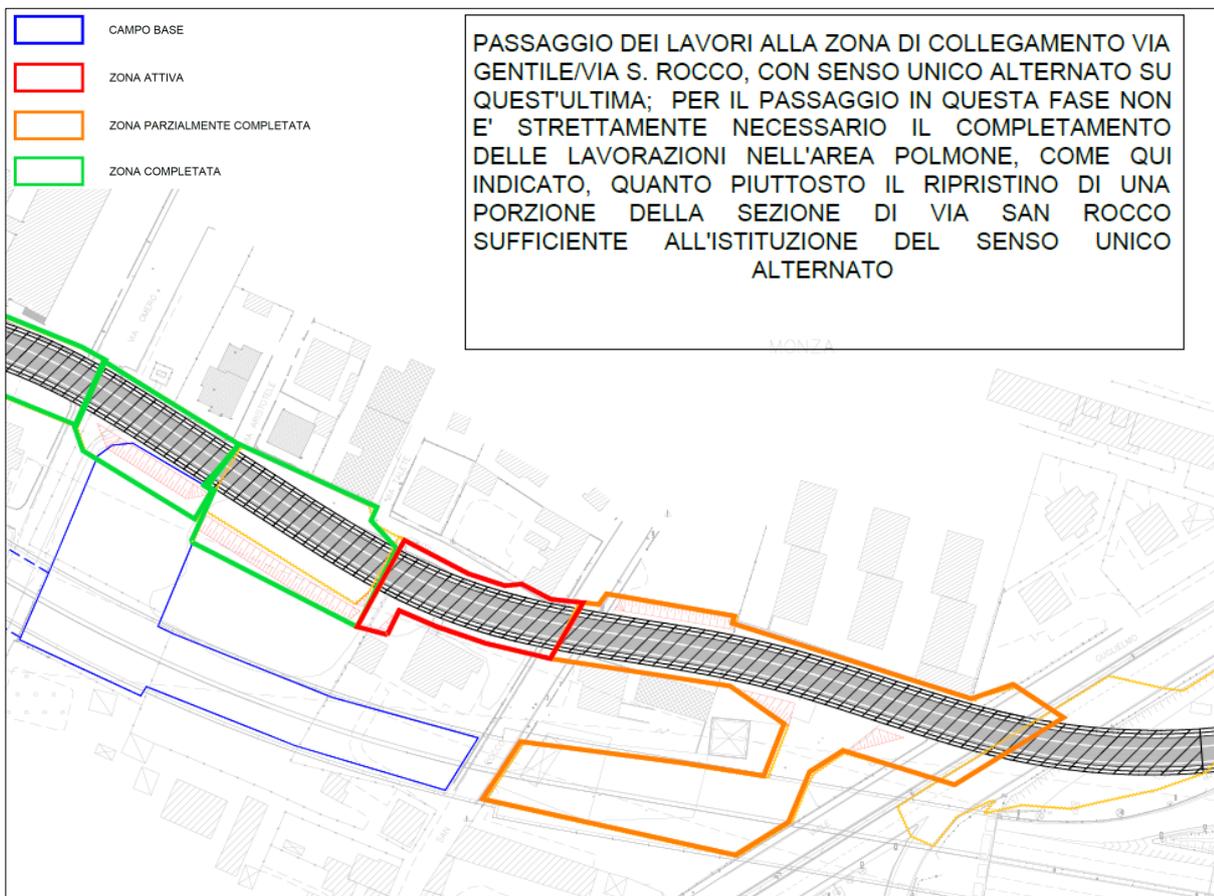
Fasi realizzazione copertura galleria del Piano di Sicurezza di progetto illustrativo della fase F di scavo della galleria.
